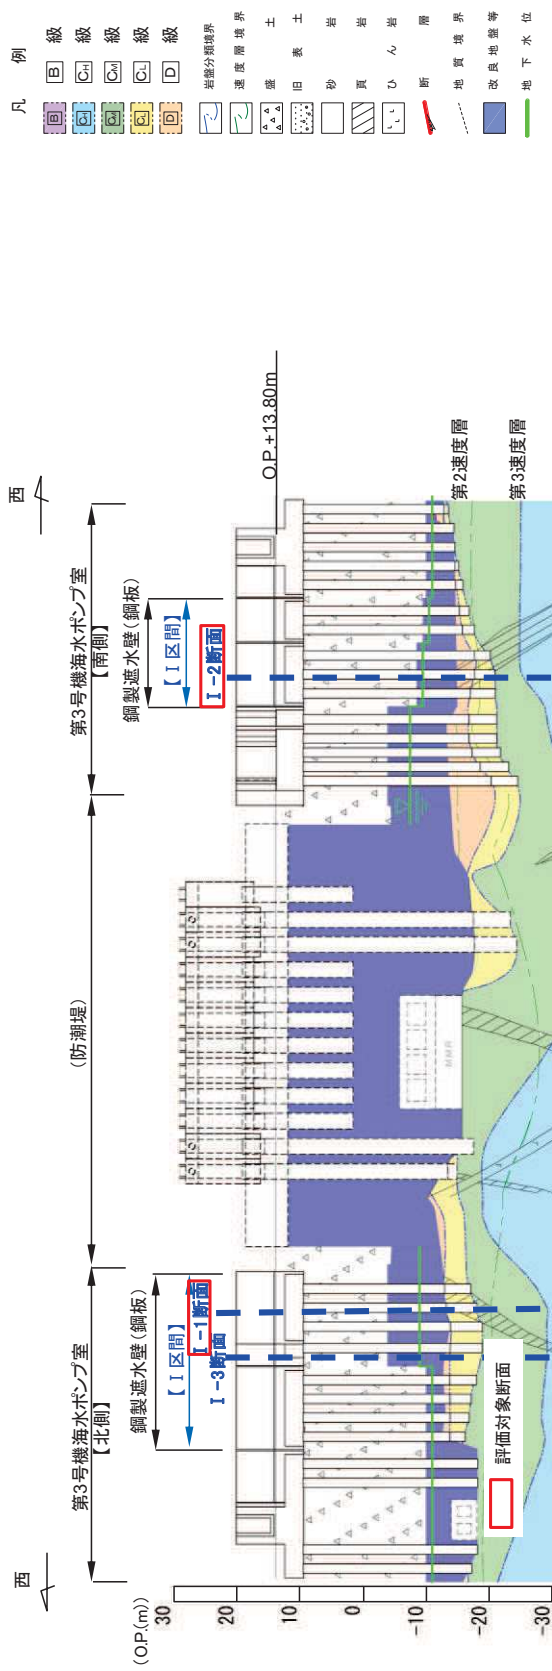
(3) 評価対象断面の地質縦断面図 (第3号機海水ポンプ室)
